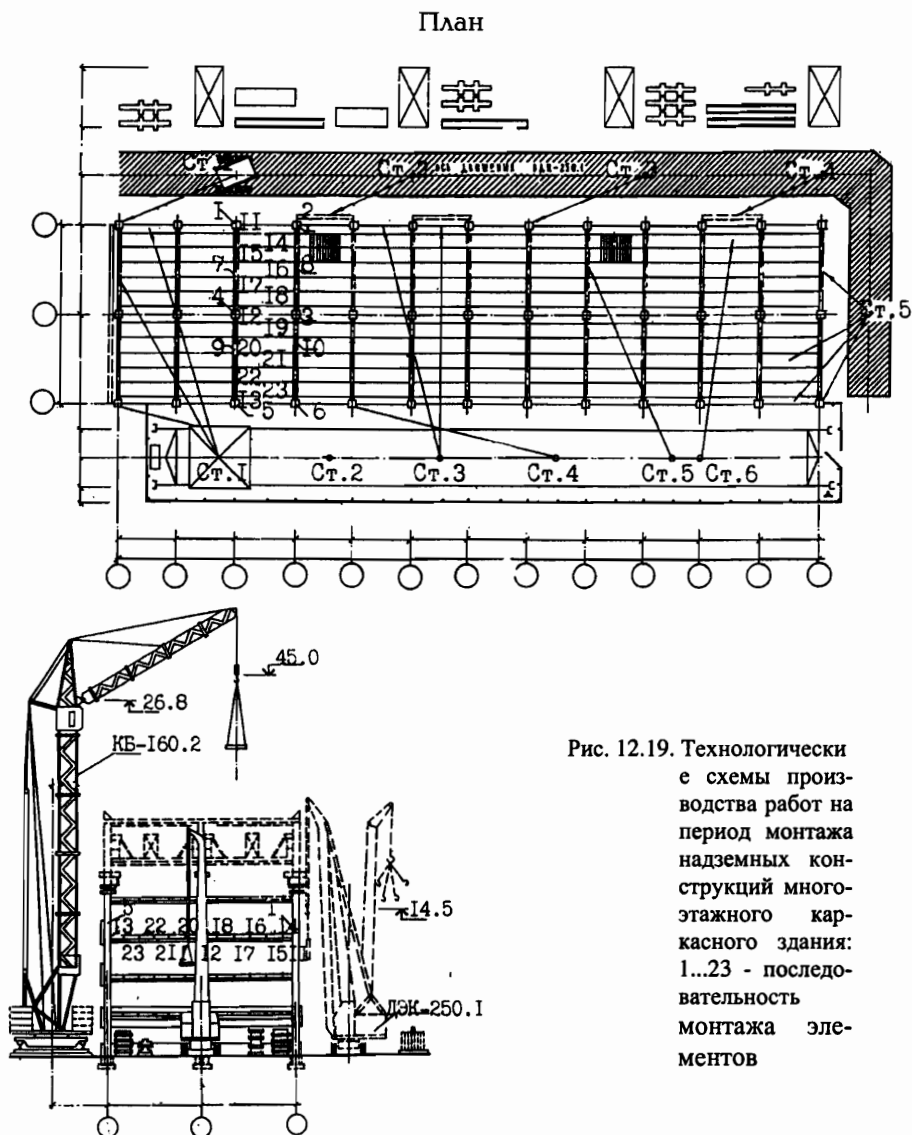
Технологические схемы производства работ на период монтажа надземных конструкций многоэтажного каркасного здания: 1...23 - последовательность монтажа элементов
